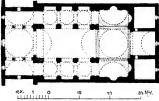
Annunziata zu Arezzo. Grundriss. (Gnauth.)
